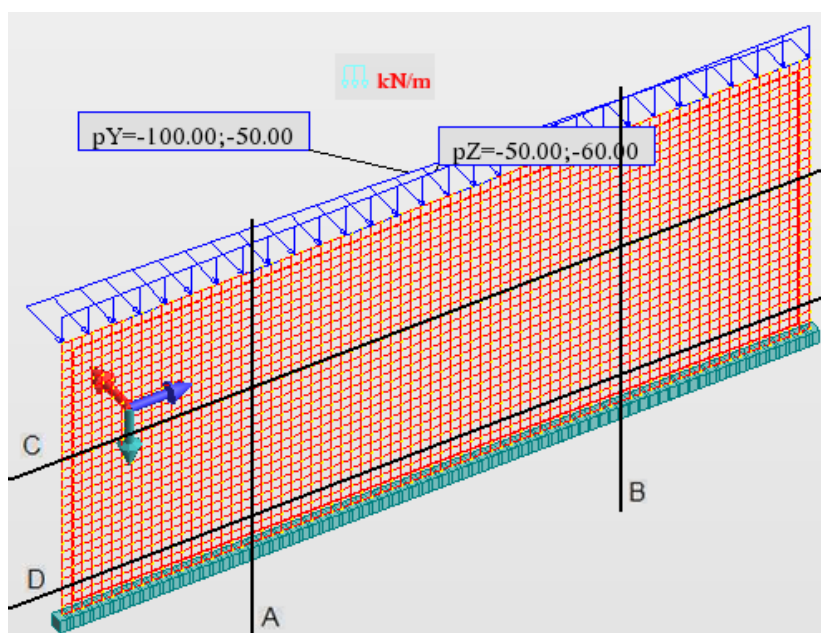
Definição do esquema estrutural e as secções a estudar a armadura.
